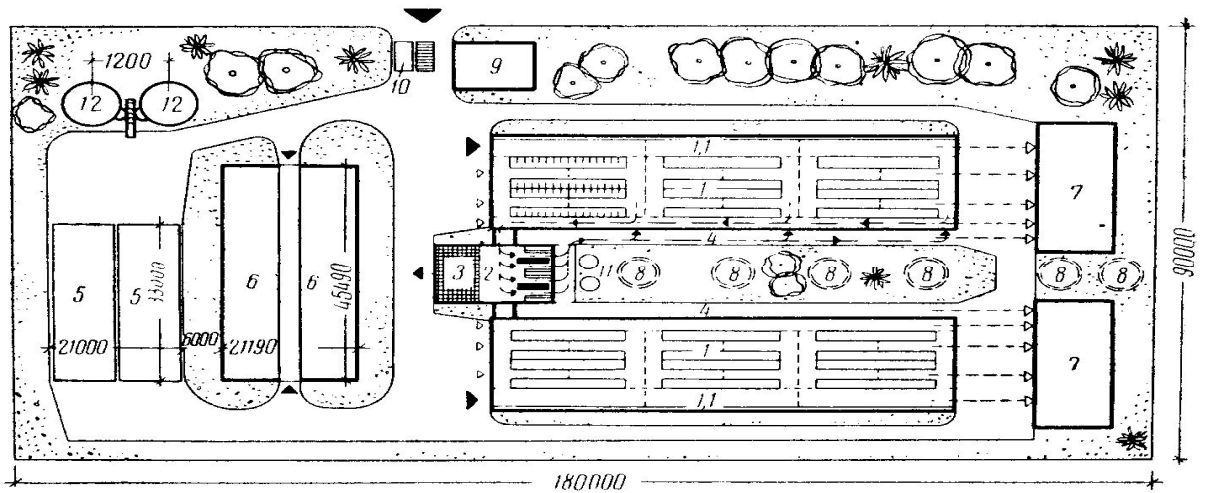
Схема генерального плану ферми для безприв'язного утримання 200 корів
